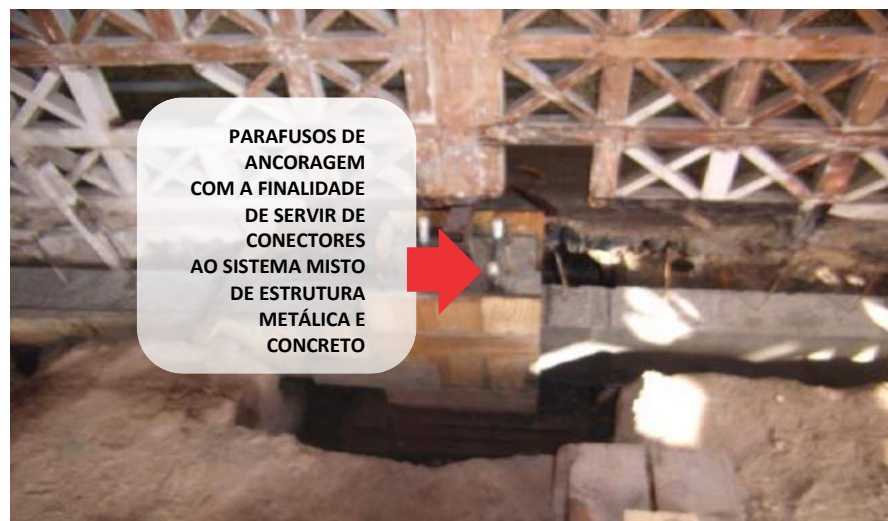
Confeção das novas fundações (metálico e concreto armado). Fonte: Arquivo DPH, 2010.
